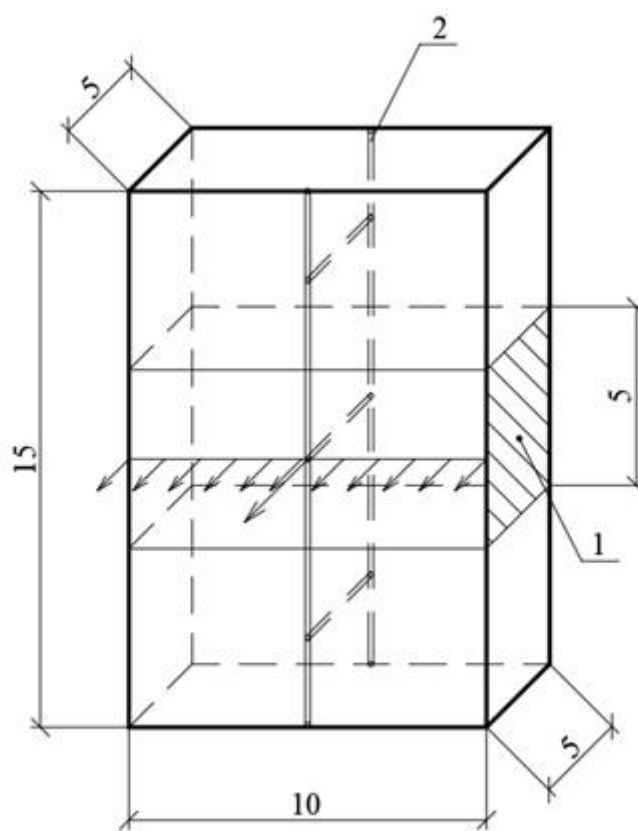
Расчетный образец защитного слоя бетона со стекловолоконной сеткой: 1 – расчетный фрагмент образца для определения усилий в бетоне и сетке; 2 – расчетный фрагмент стекловолоконной сетки
